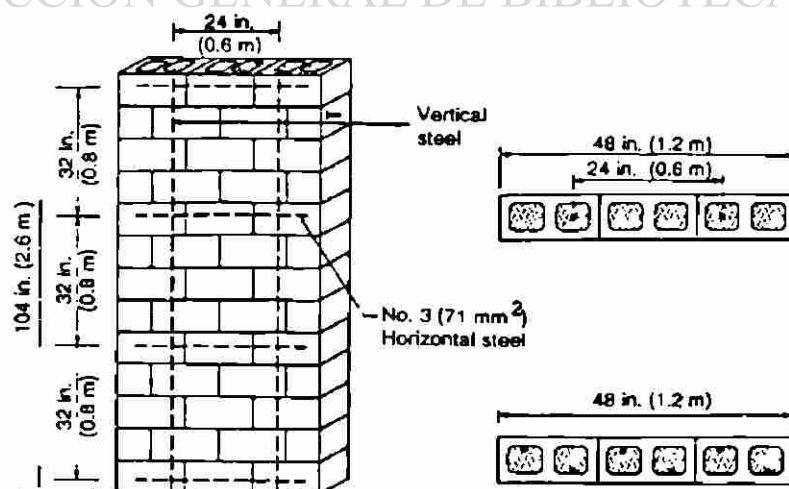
Pruebas en muros de mampostería reforzada soportados verticalmente.
